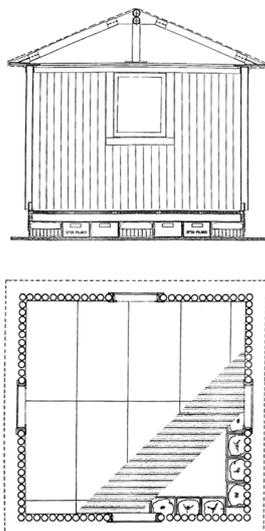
Planimetrías Paper Log House, modelo de Japón.
